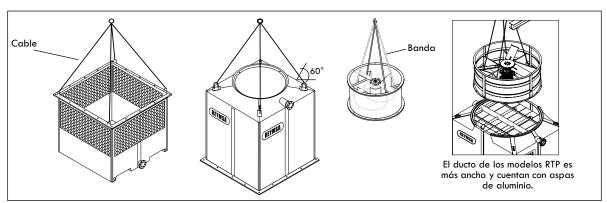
Levantamiento con grúa de una torre de un ventilador
